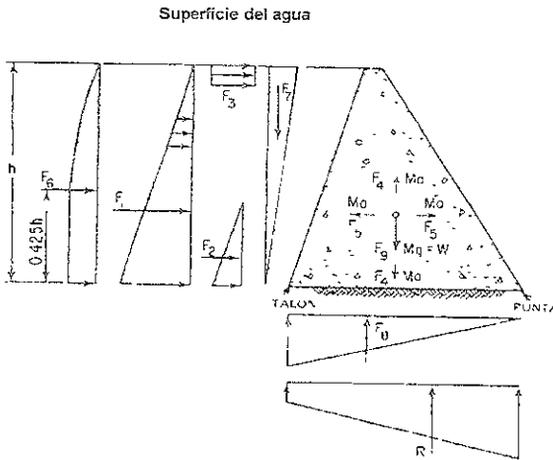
Fuerzas que actúan en una presa de gravedad de concreto
